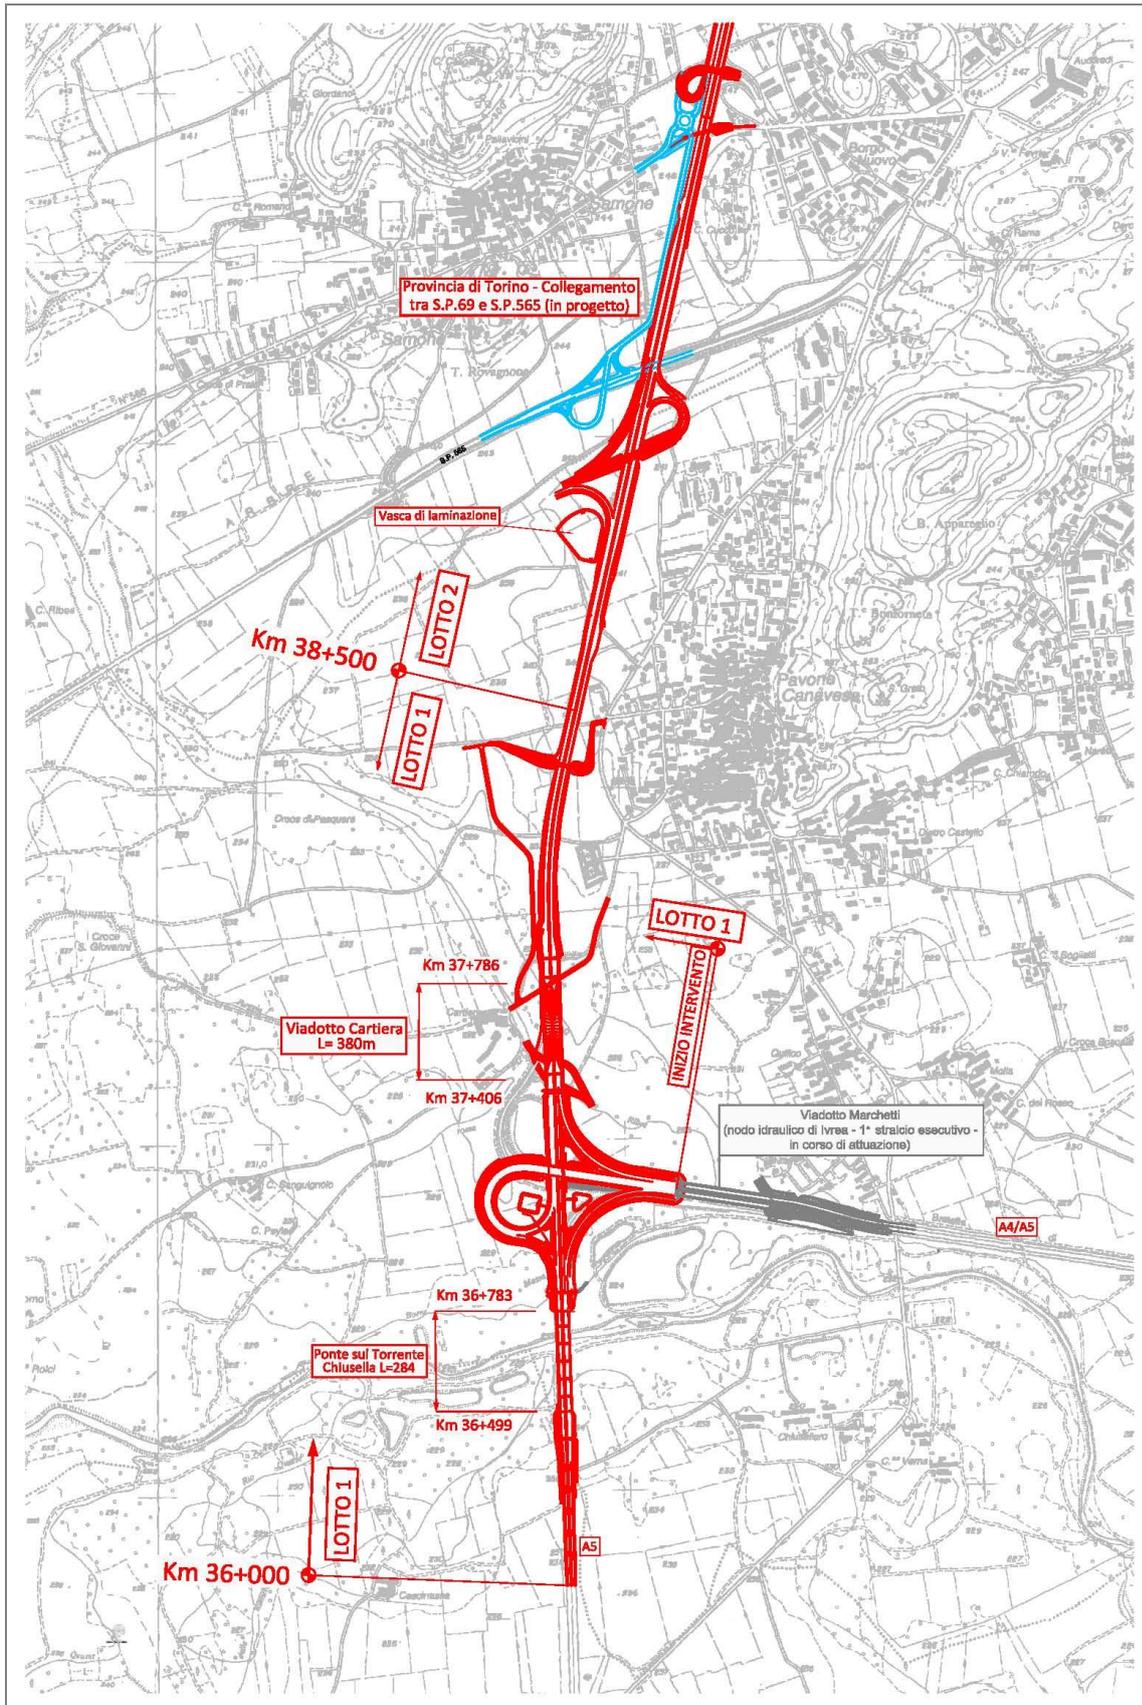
/2: opere in progetto – Lotto 1 e Lotto 2
